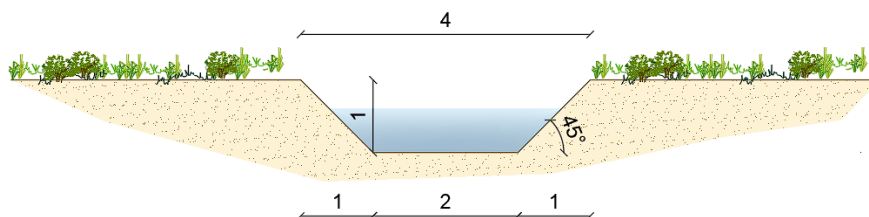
Sezione trasversale del canale in progetto "Tipo 1"
